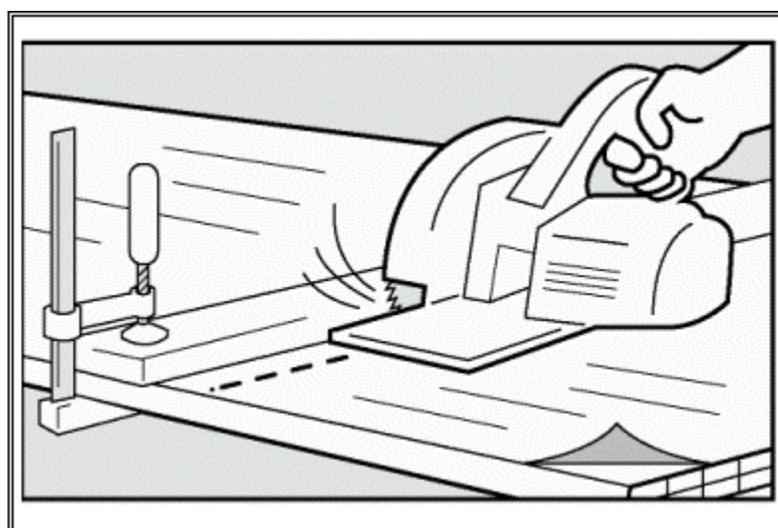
Corte transversal a los alvéolos con sierra eléctrica.
